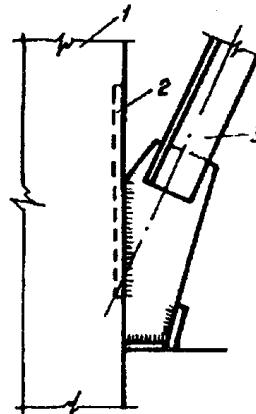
Схема дефектного примыкания вертикальных связей к колонне при смещении закладной детали в ней:
